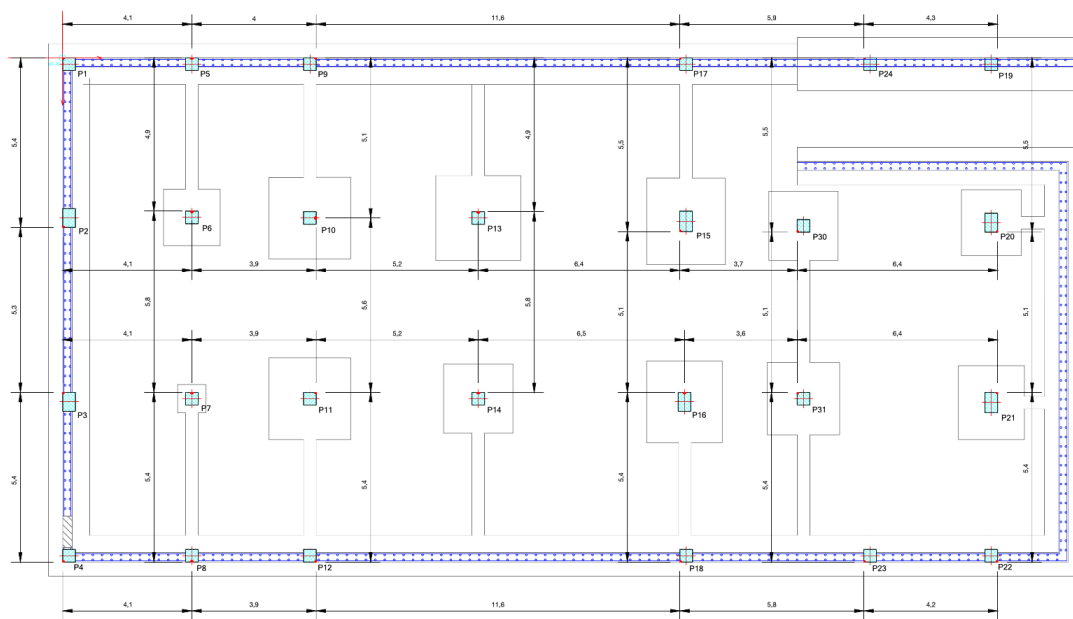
PLANO DE REPLANTEO DE PILARES CON LOS PUNTOS DE CRECIMIENTO
